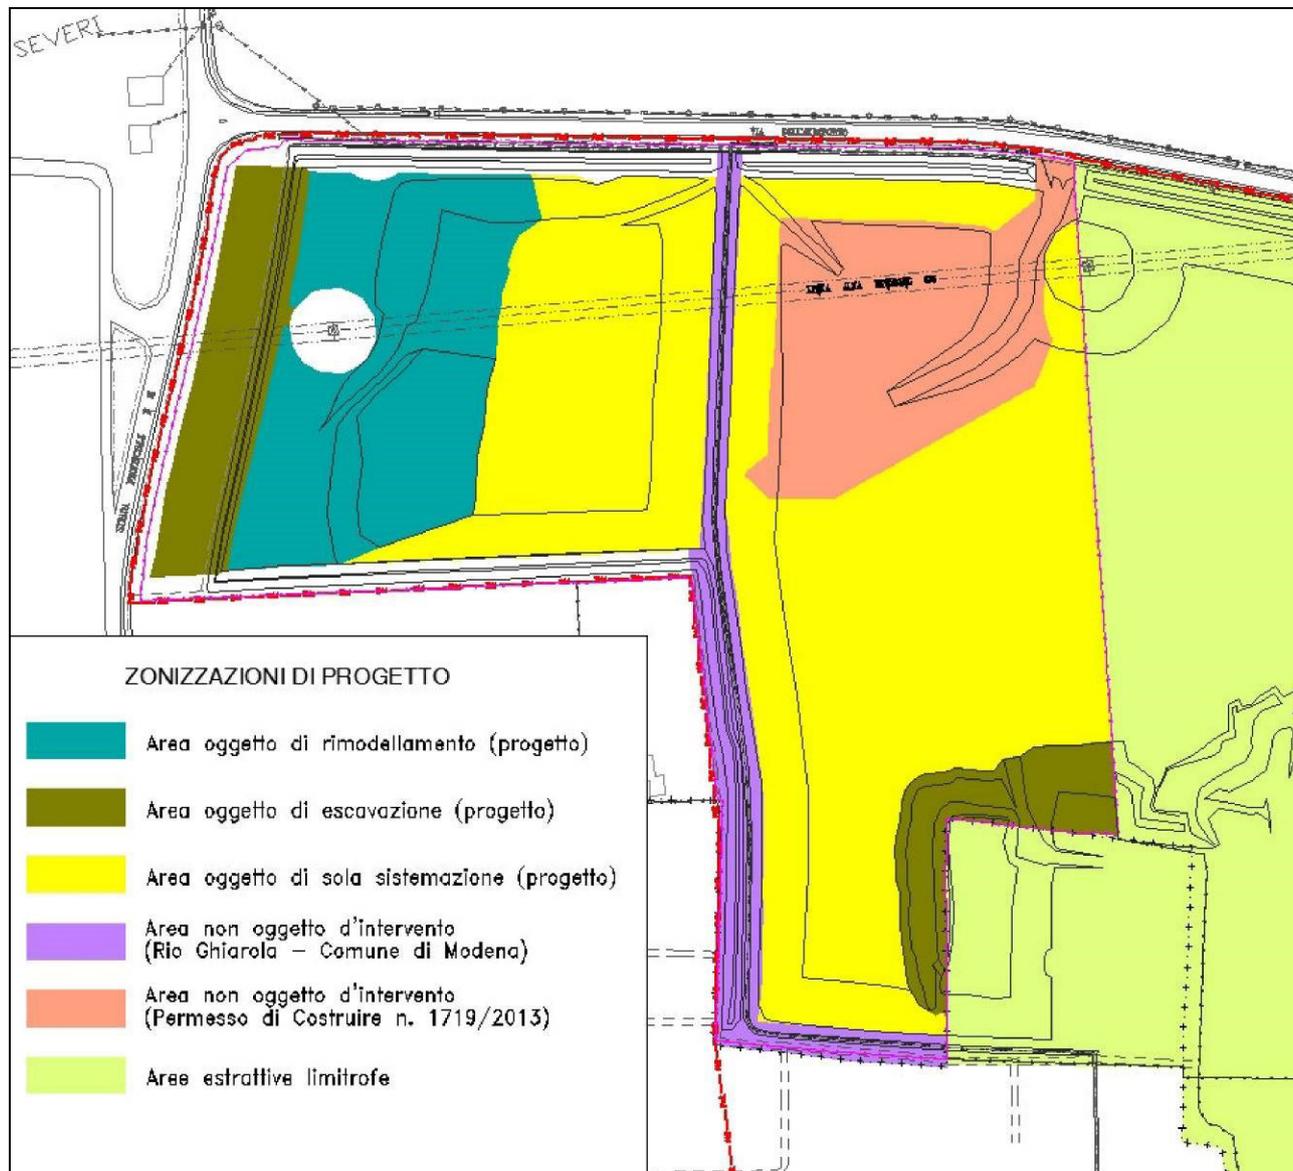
Zonizzazione degli interventi (Stralcio di Tav. CT1 "Planimetria dello stato di fatto – Zonizzazione degli interventi")
